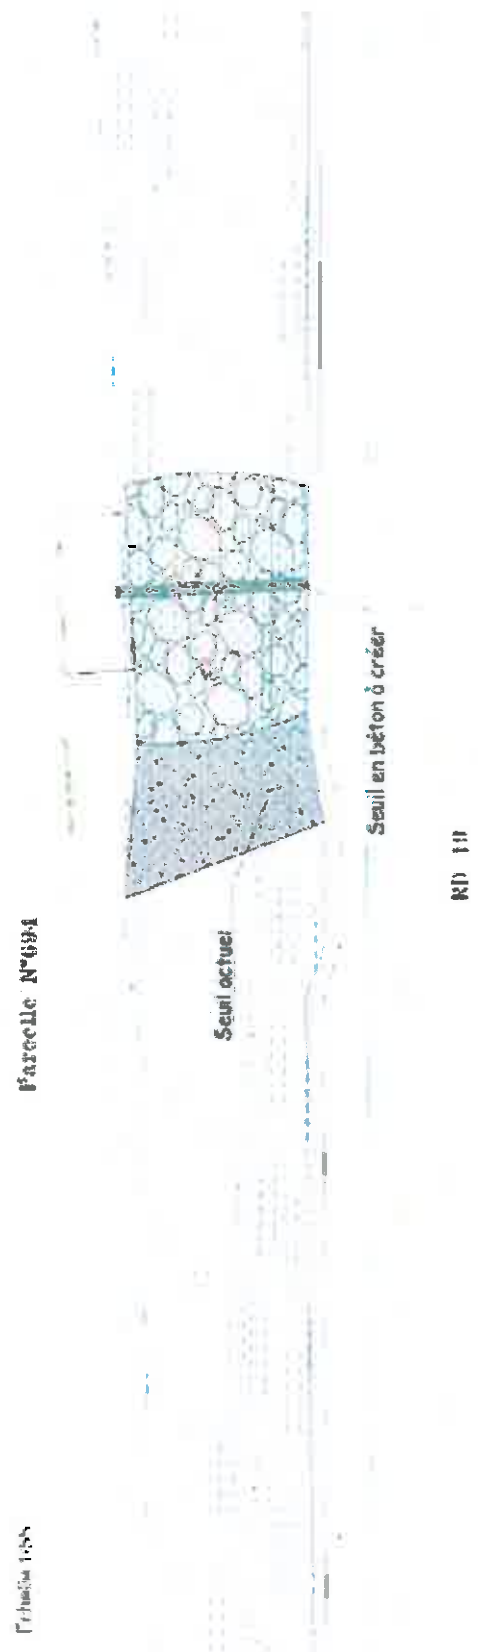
Vue en plan du pré-barrage au niveau du seuil de la RD19
